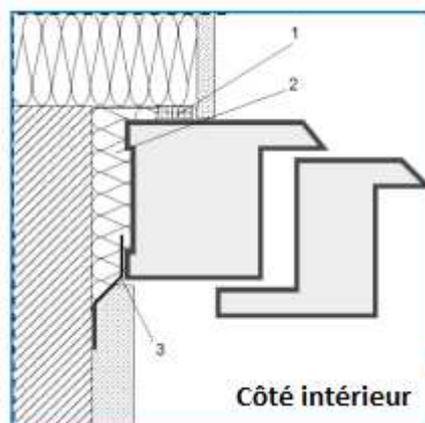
Étanchéité de l'espace entre la fenêtre et le dormant dans un mur avec isolation extérieure
